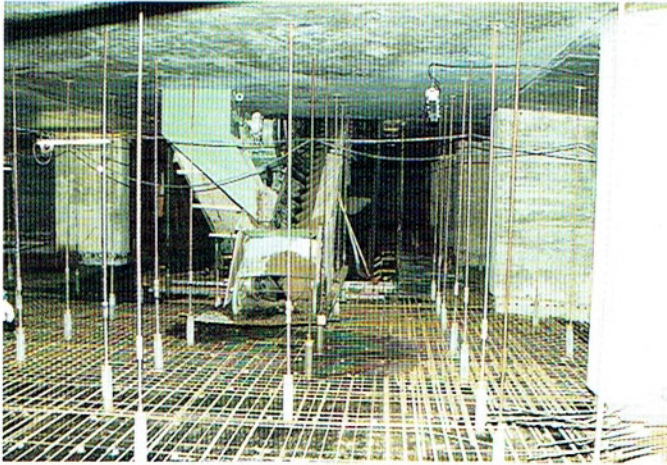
Teilbewehrte hängende Decke und Förderbänder
